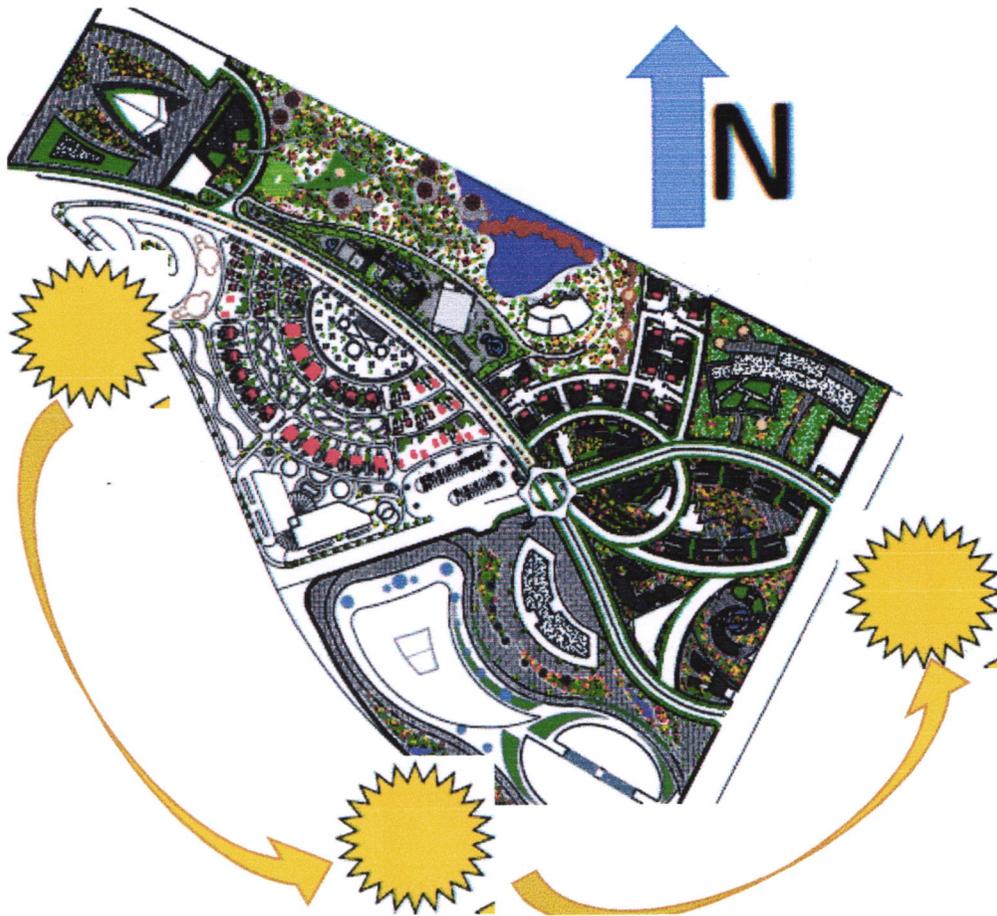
Schéma d'ensoleillement du plan d'aménagement
